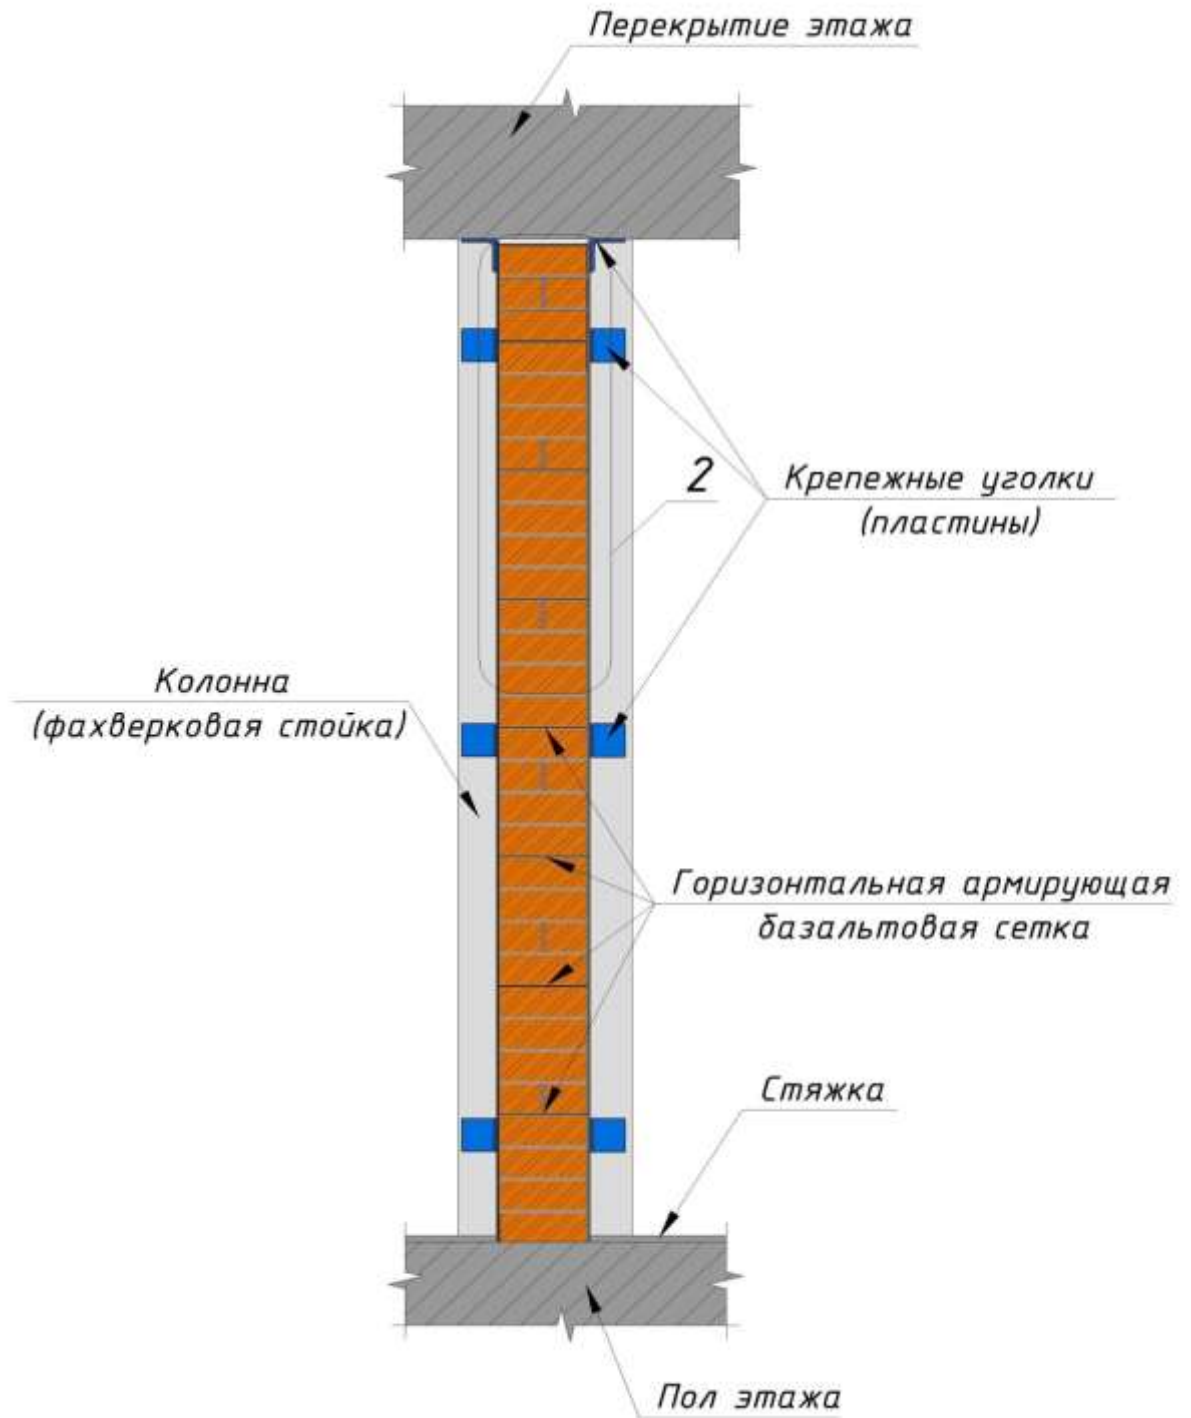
Схема крепления перегородки из различных стеновых материалов, усиленной композитной сеткой, к каркасу здания при толщине перегородки 25 см и более
